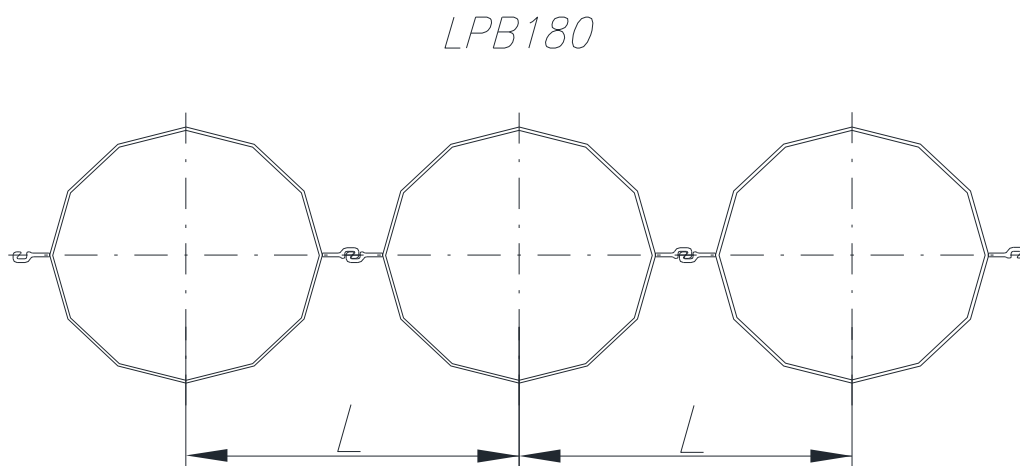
Поперечное сечение стены из шпунта ТСС с замковым профилем LPB180
